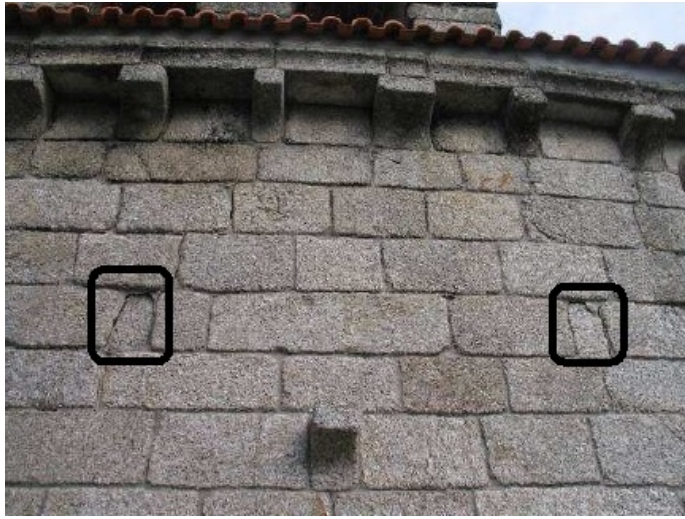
Localização dos travadores nas paredes de cantaria (Silva, 2008)
